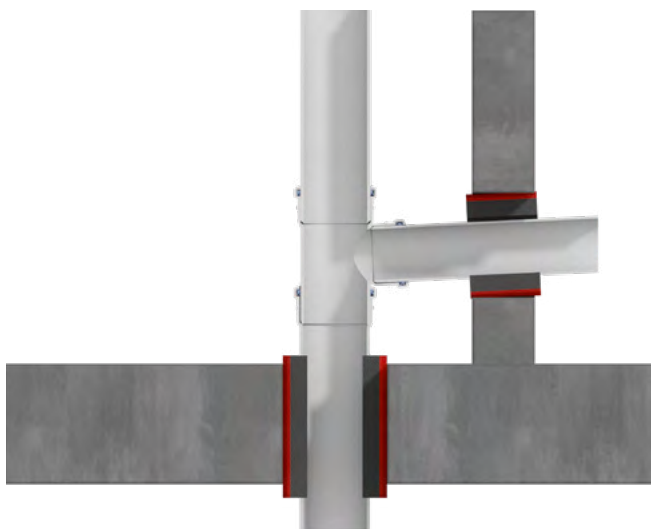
Decken- und Wanddurchführungen Wavin AS+
